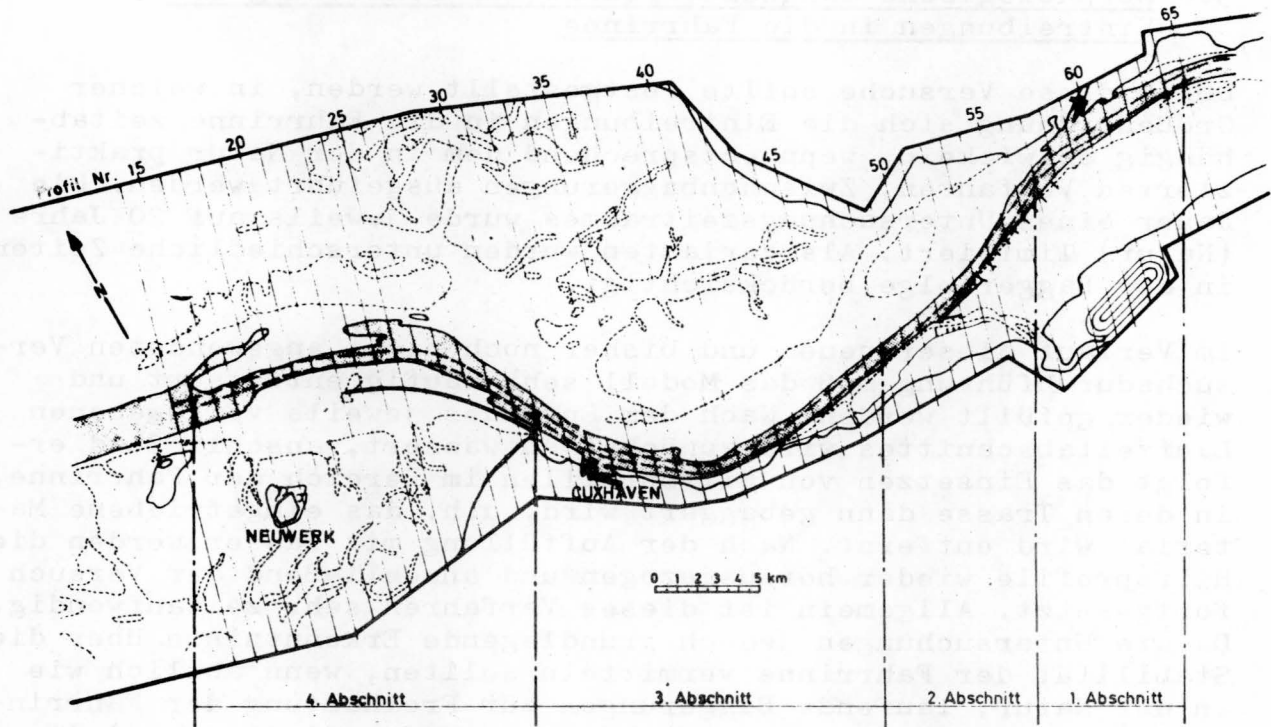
Lageplan des Elbeästuars zwischen St. Margarethen und der See mit der Trasse der Hauptfahrrinne nach dem 13,5 m-Ausbau
